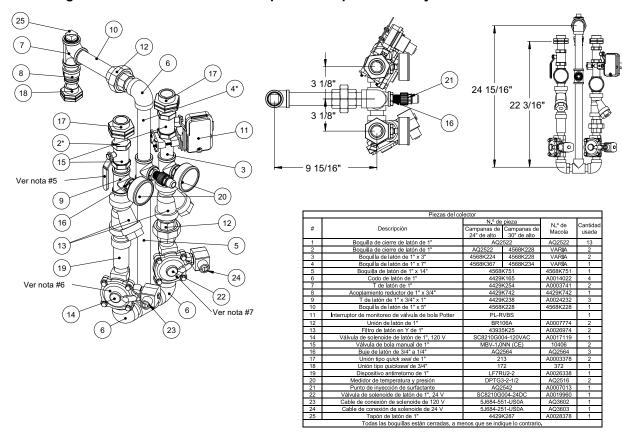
Detalle del colector de protección para cámara y conducto CORE de 3/4"
